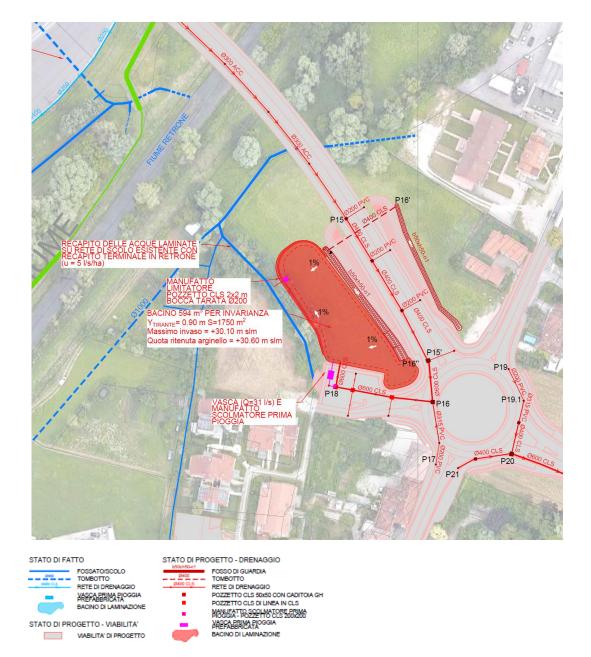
schema di deflusso afferente al bacino di laminazione AP\_ROT2
